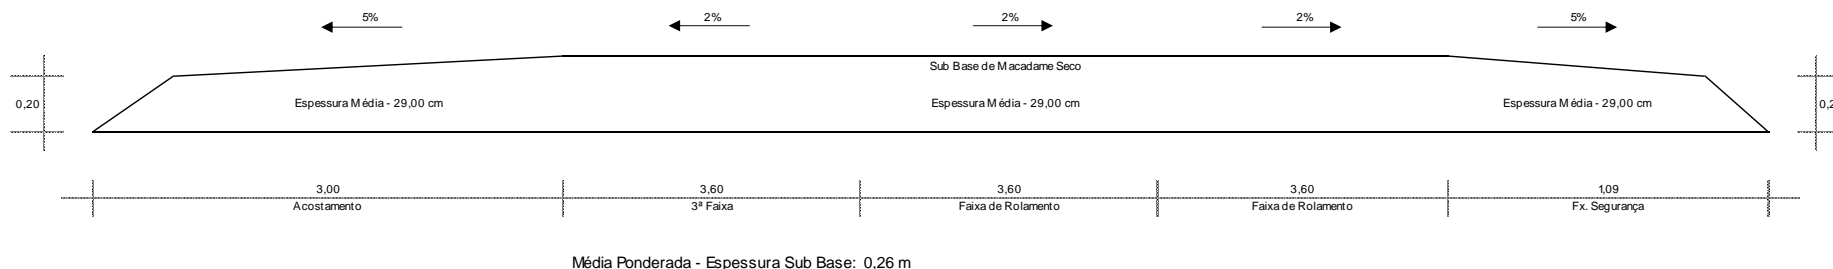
Seção Transversal Tipo de Pavimentação – Pista Principal – Tipo 3
